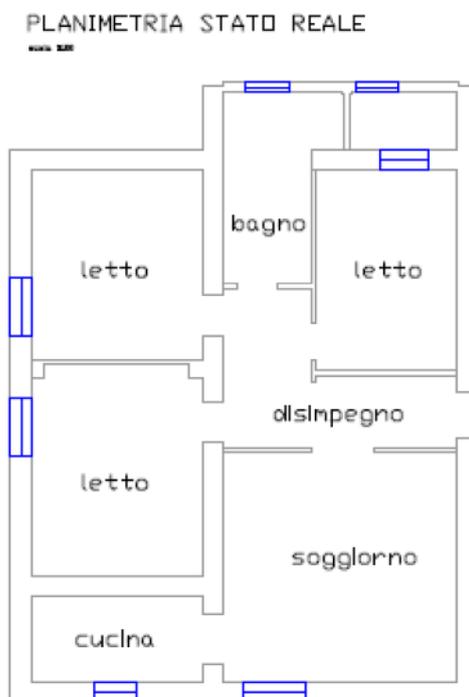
Planimetria dello stato reale dei luoghi (cf. all. 12)
